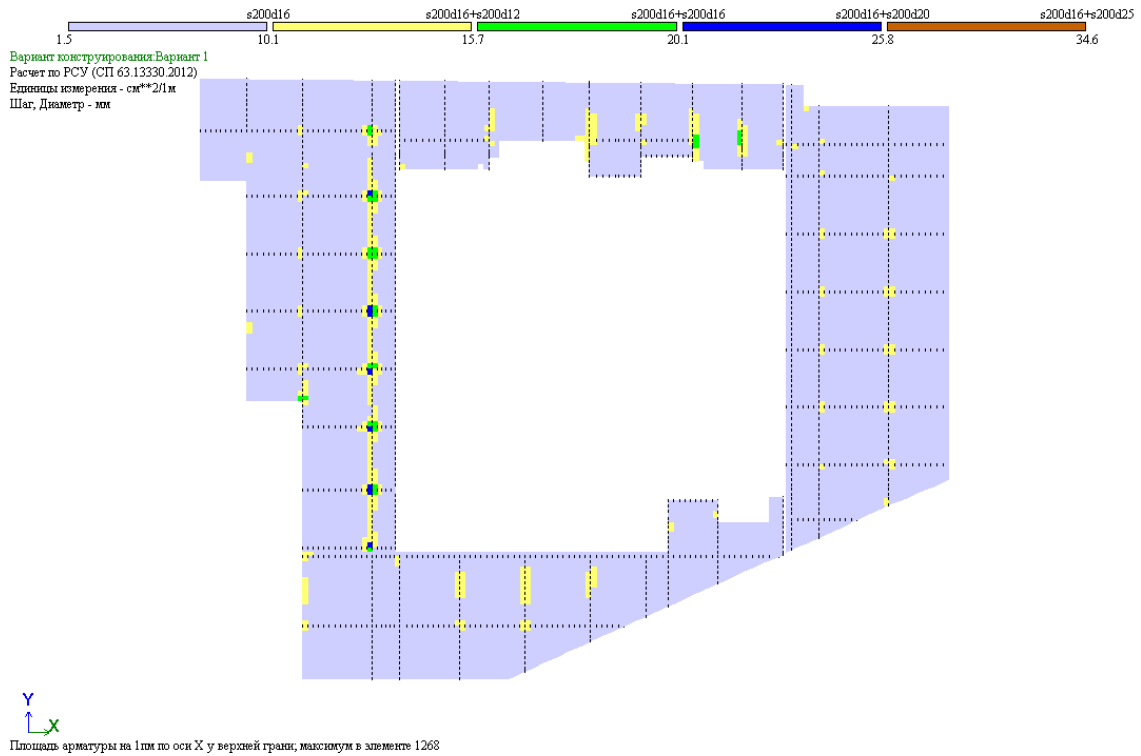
Площадь арматуры в плите у верхней грани по оси X
